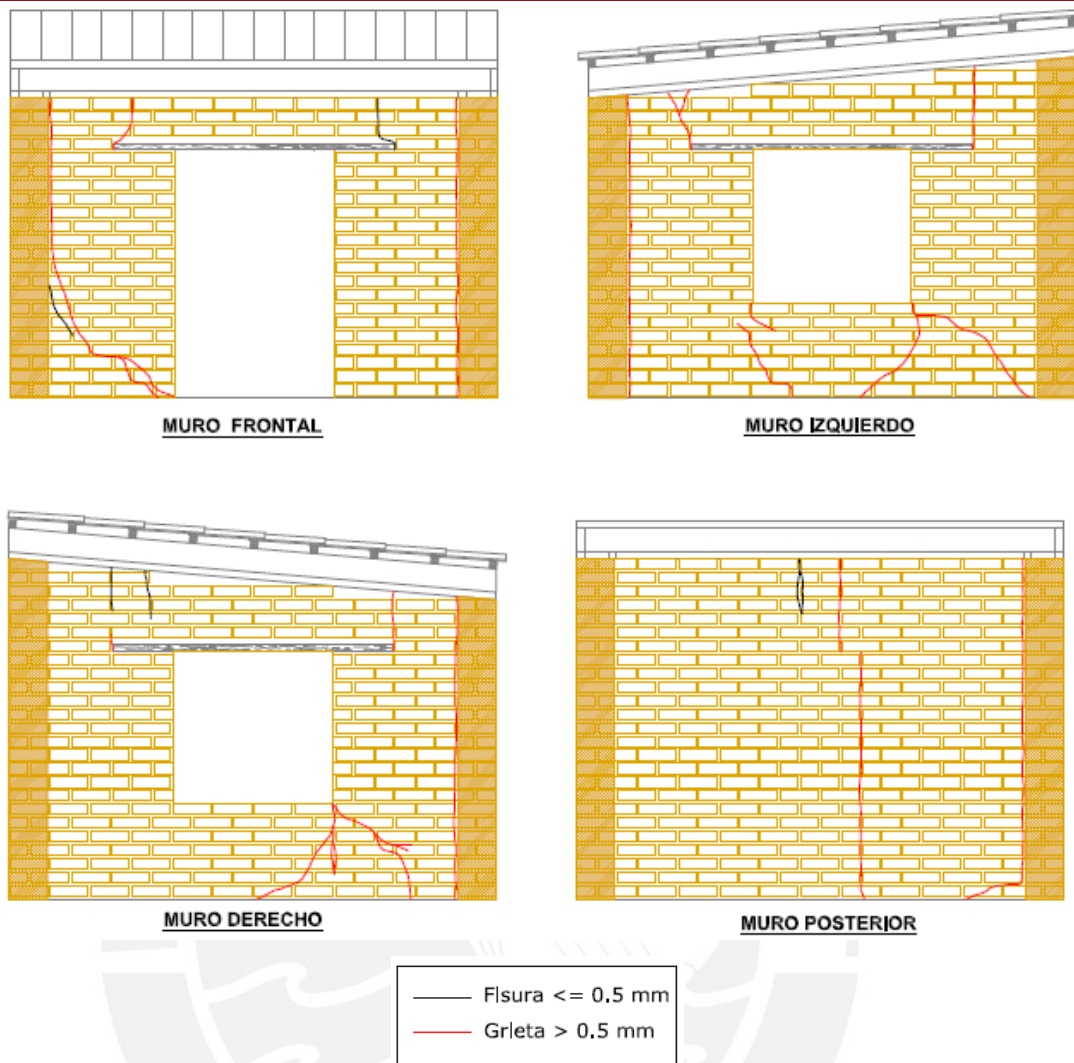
Fisuras y grietas interiores en muros – Módulo M100-T4100D
